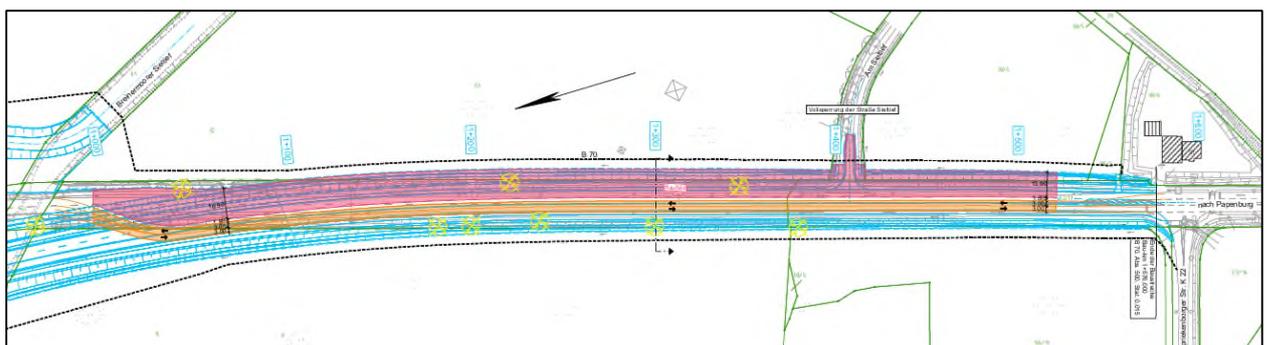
Lageplan Bauphasenplan Süd, Bauphase D3
